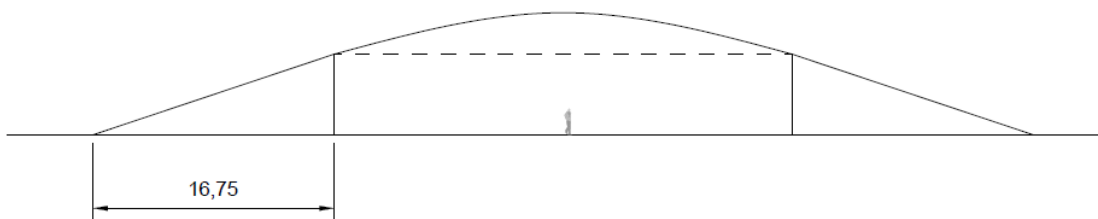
Distribución en alzado de la alternativa con pilares inclinados Fuente: Elaboración propia
